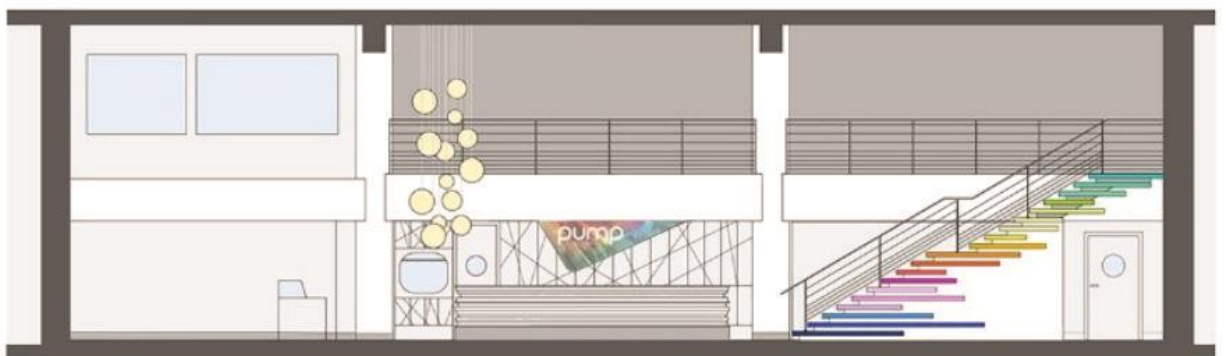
Vista da entrada da Academia Pump. Fonte: Site Archdaily (2018).
